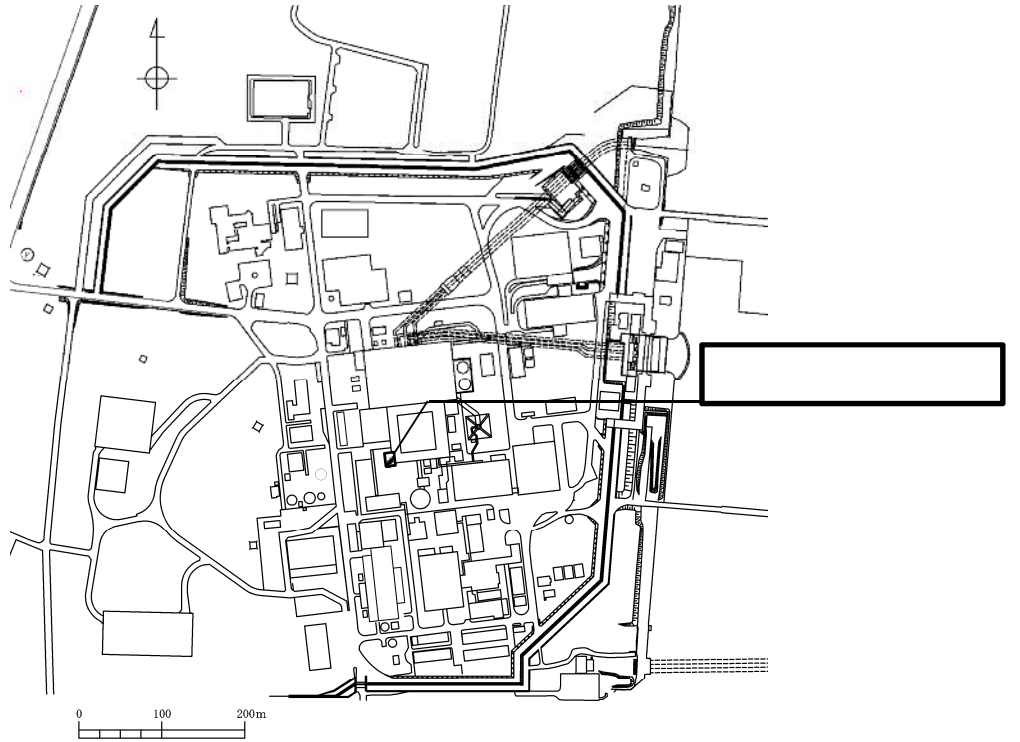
(1) カルバートの平面配置図 (全体平面図)
